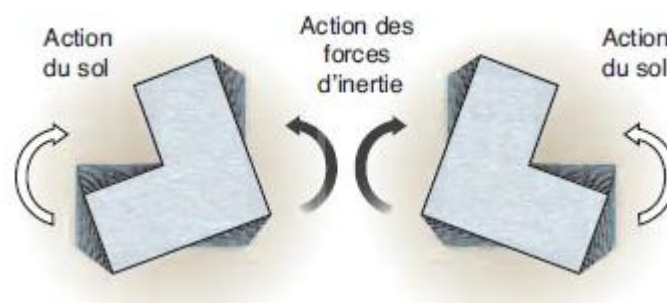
Forces d'inertie et torsion (extrait Cimbeton – Béton et construction parasismique - 2009)
